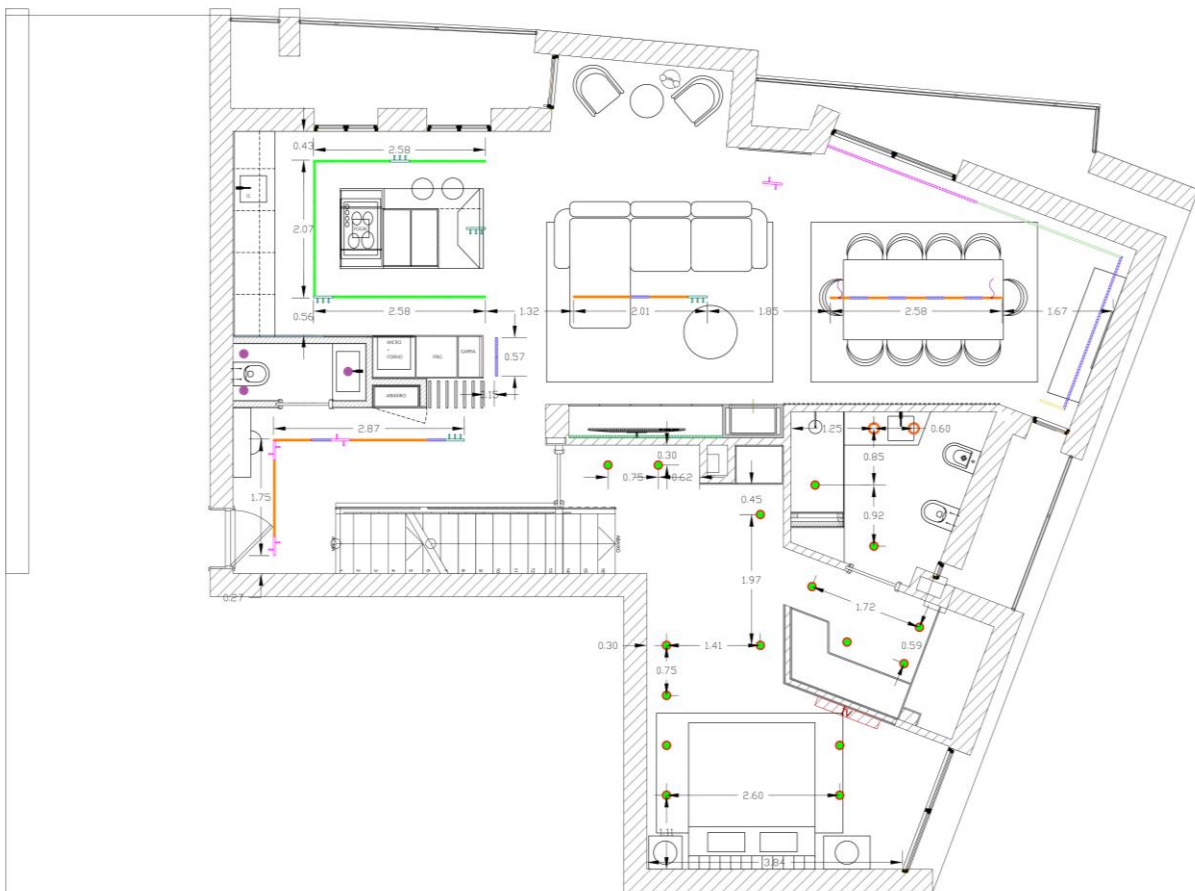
Planta de iluminação | Piso 0. Fonte: 2L'atelier
